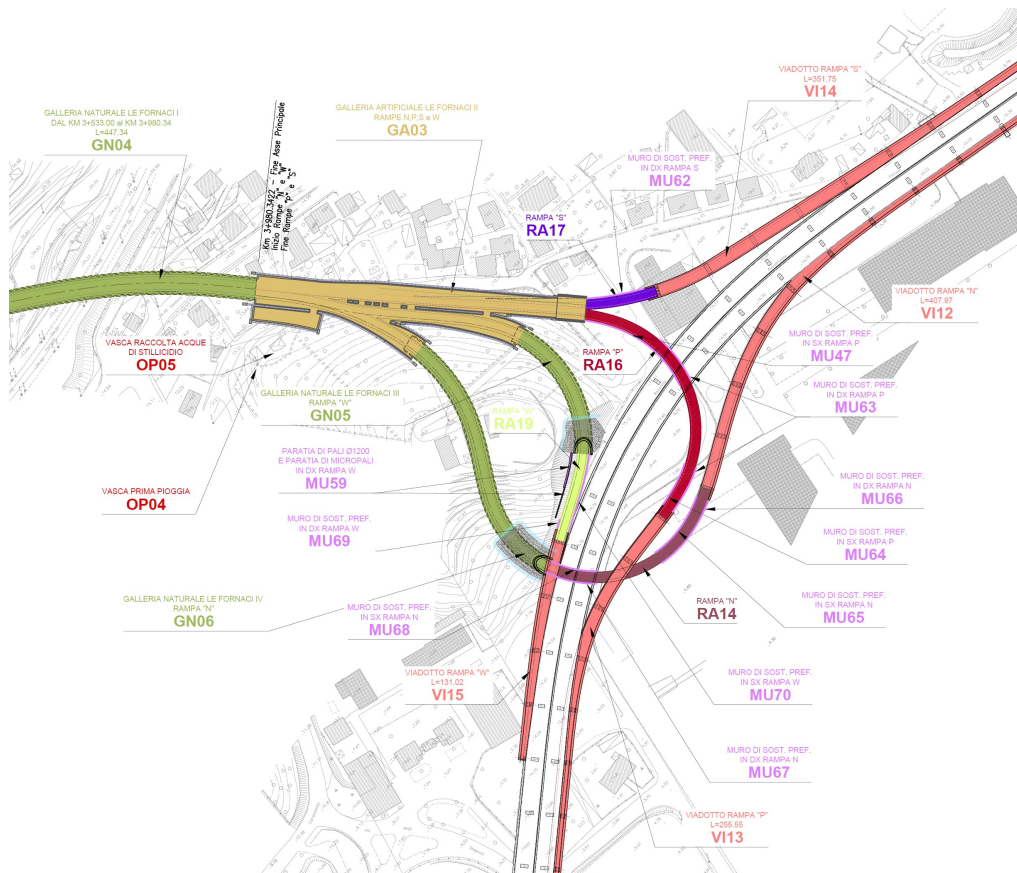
Stralcio planimetrico dello Svincolo Melara.
